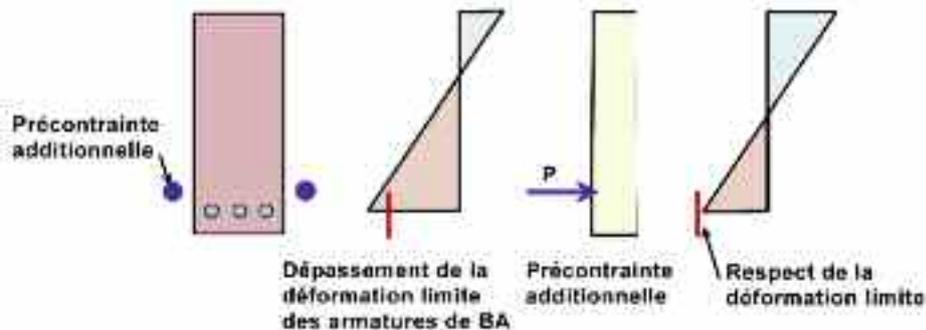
hypothèses de calcul pour dimensionner la réparation ou le renforcement d'une section de béton armé par précontrainte additionnelle
